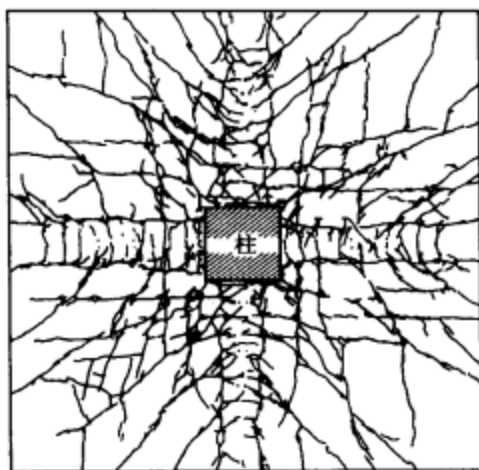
钢筋混凝土梁-板-柱试件破坏后的裂缝分布
